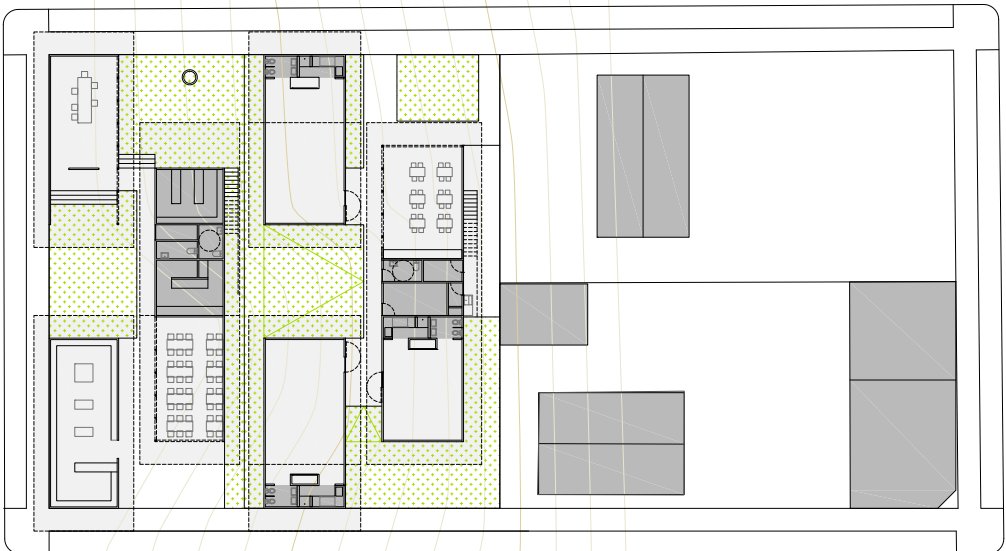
Primera propuesta. Primer piso con el terreno dividido en Centro de Artesanía (hacia el río) y Cuna Más (al interior). Elaboración: Equipo proyectual, 2016
